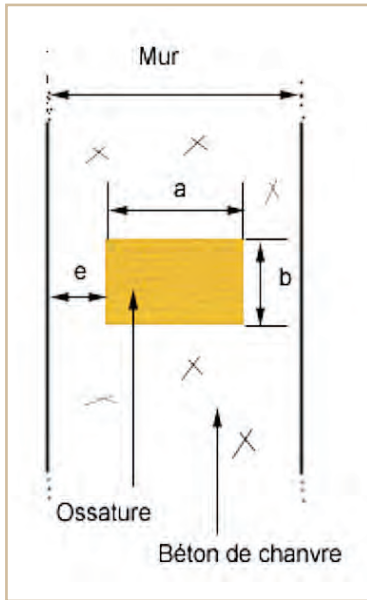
Coupe horizontale du mur ; épaisseur d'enrobage (e) et section de bois (a et b)
